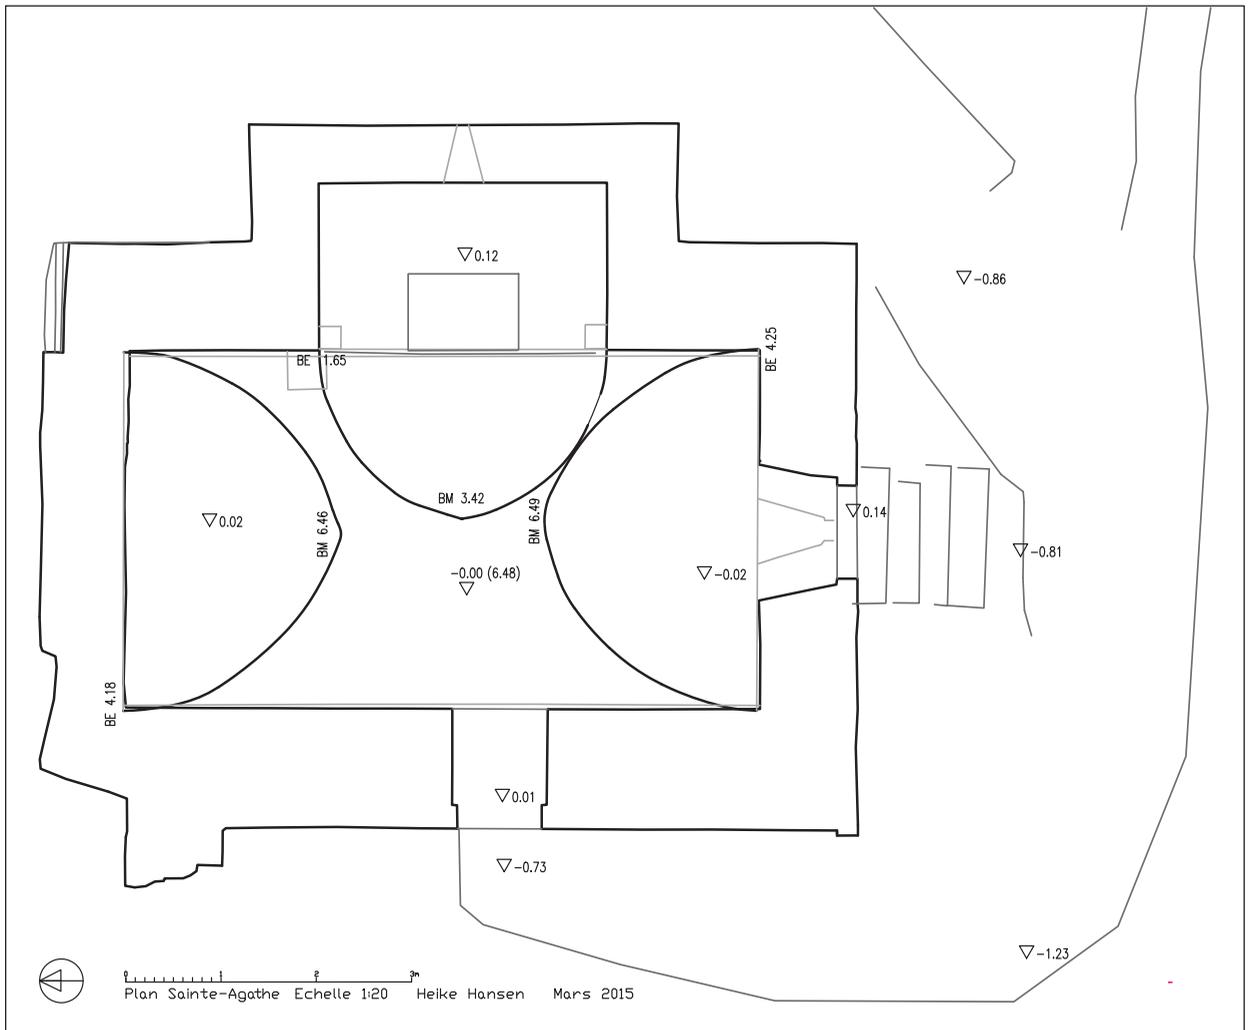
plan de la chapelle (dressé par Heike HANSEN, archéo-topographe).
